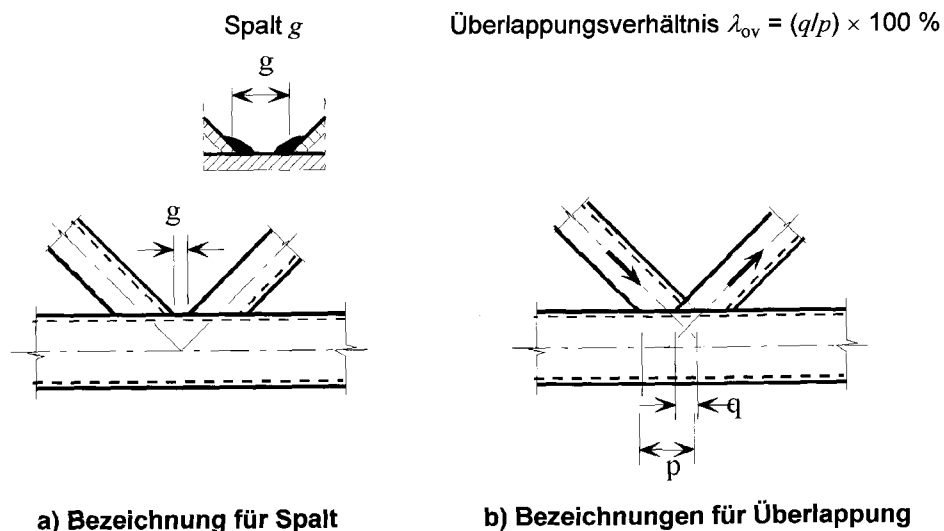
Knotenanschlüsse mit Spalt und mit Überlappung
